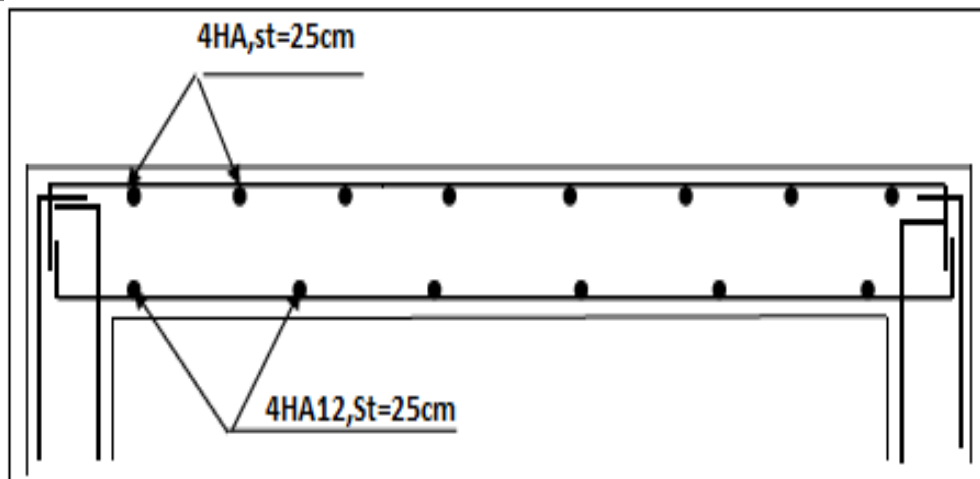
Plan de ferrailage de la salle machine suivant x-x
